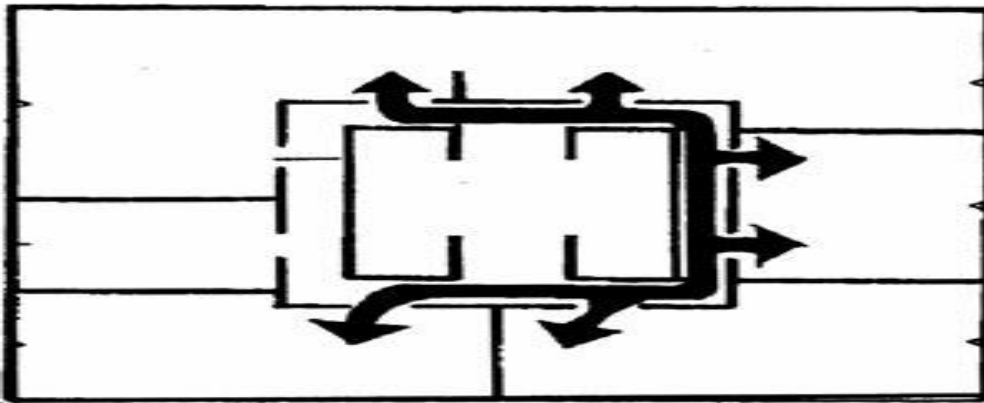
типовий план поверху будівлі каркасного будинку з легкими стінами.
